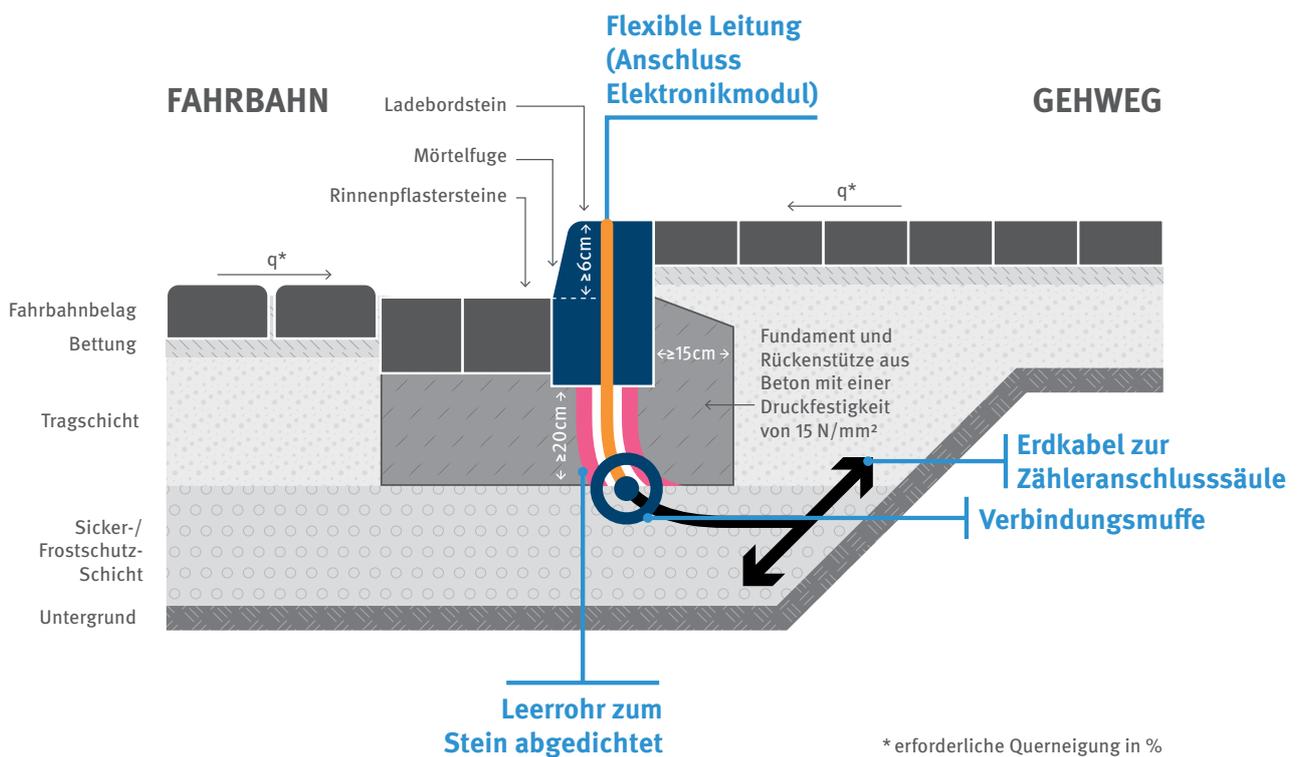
Verbau Bordsteinkörper mit exemplarischem Oberbau
